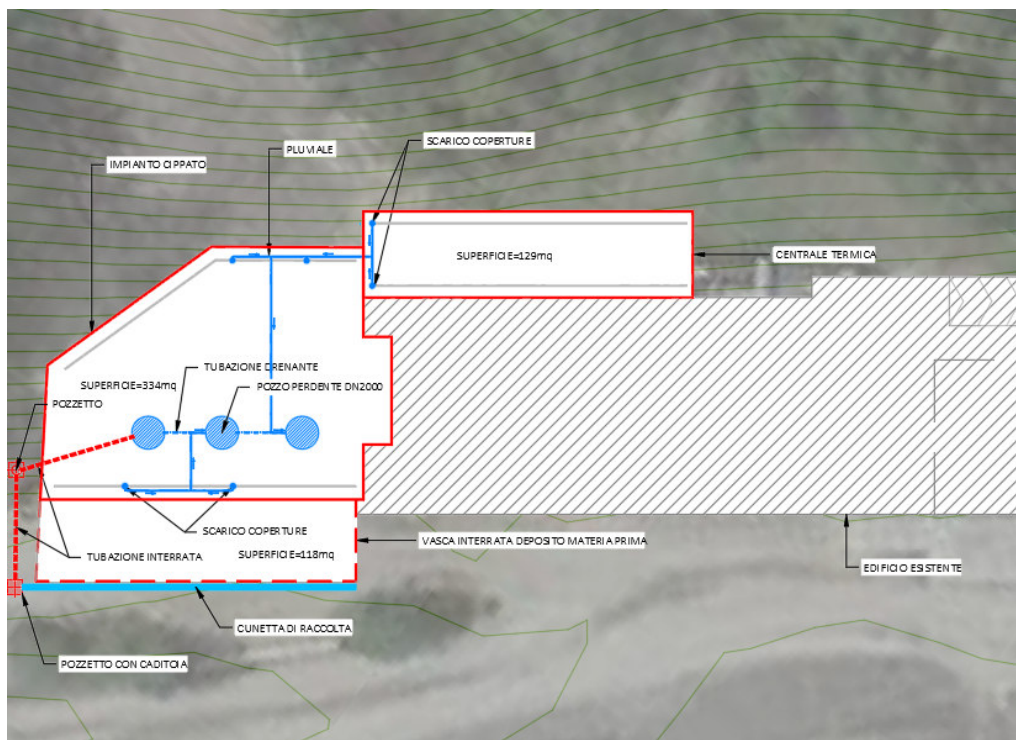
Aree scolanti e schema opere in progetto, stralcio planimetria di inquadramento, tavola 3122_5695_T01_Rev0_INQ_GEN_IDRAULICA
